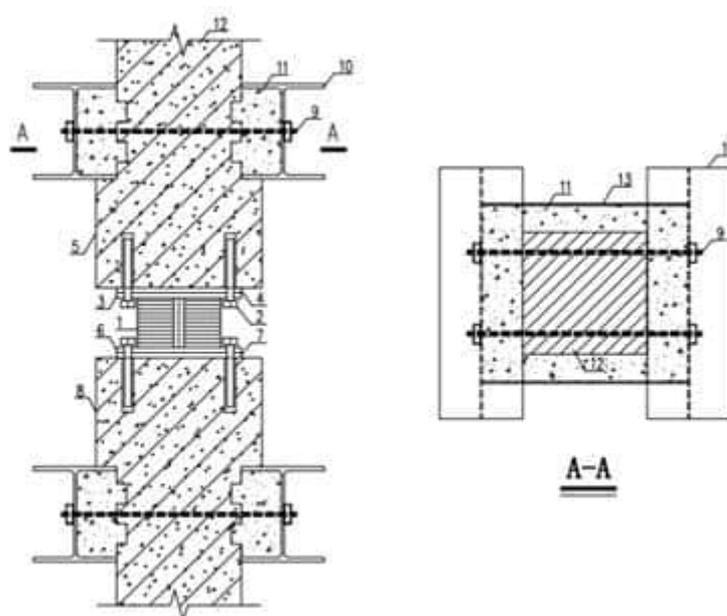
框架柱托换及隔震支座安装示意图（采用的型钢混凝土托换节点）
